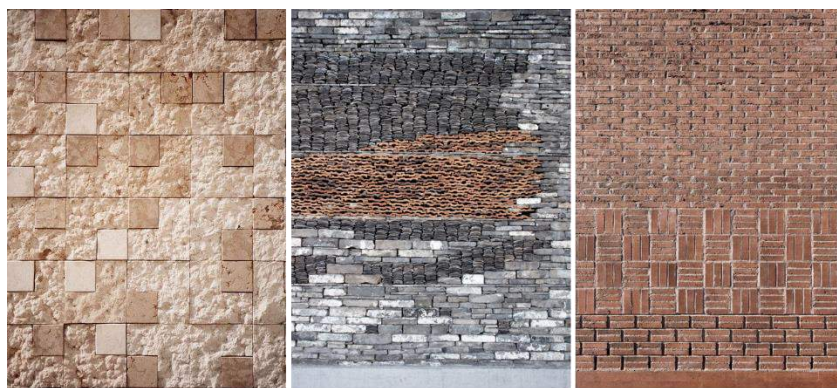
Disposição de vários materiais em fachada. Por ordem: Pedra, Pedra e Telhas, Tijolo.
